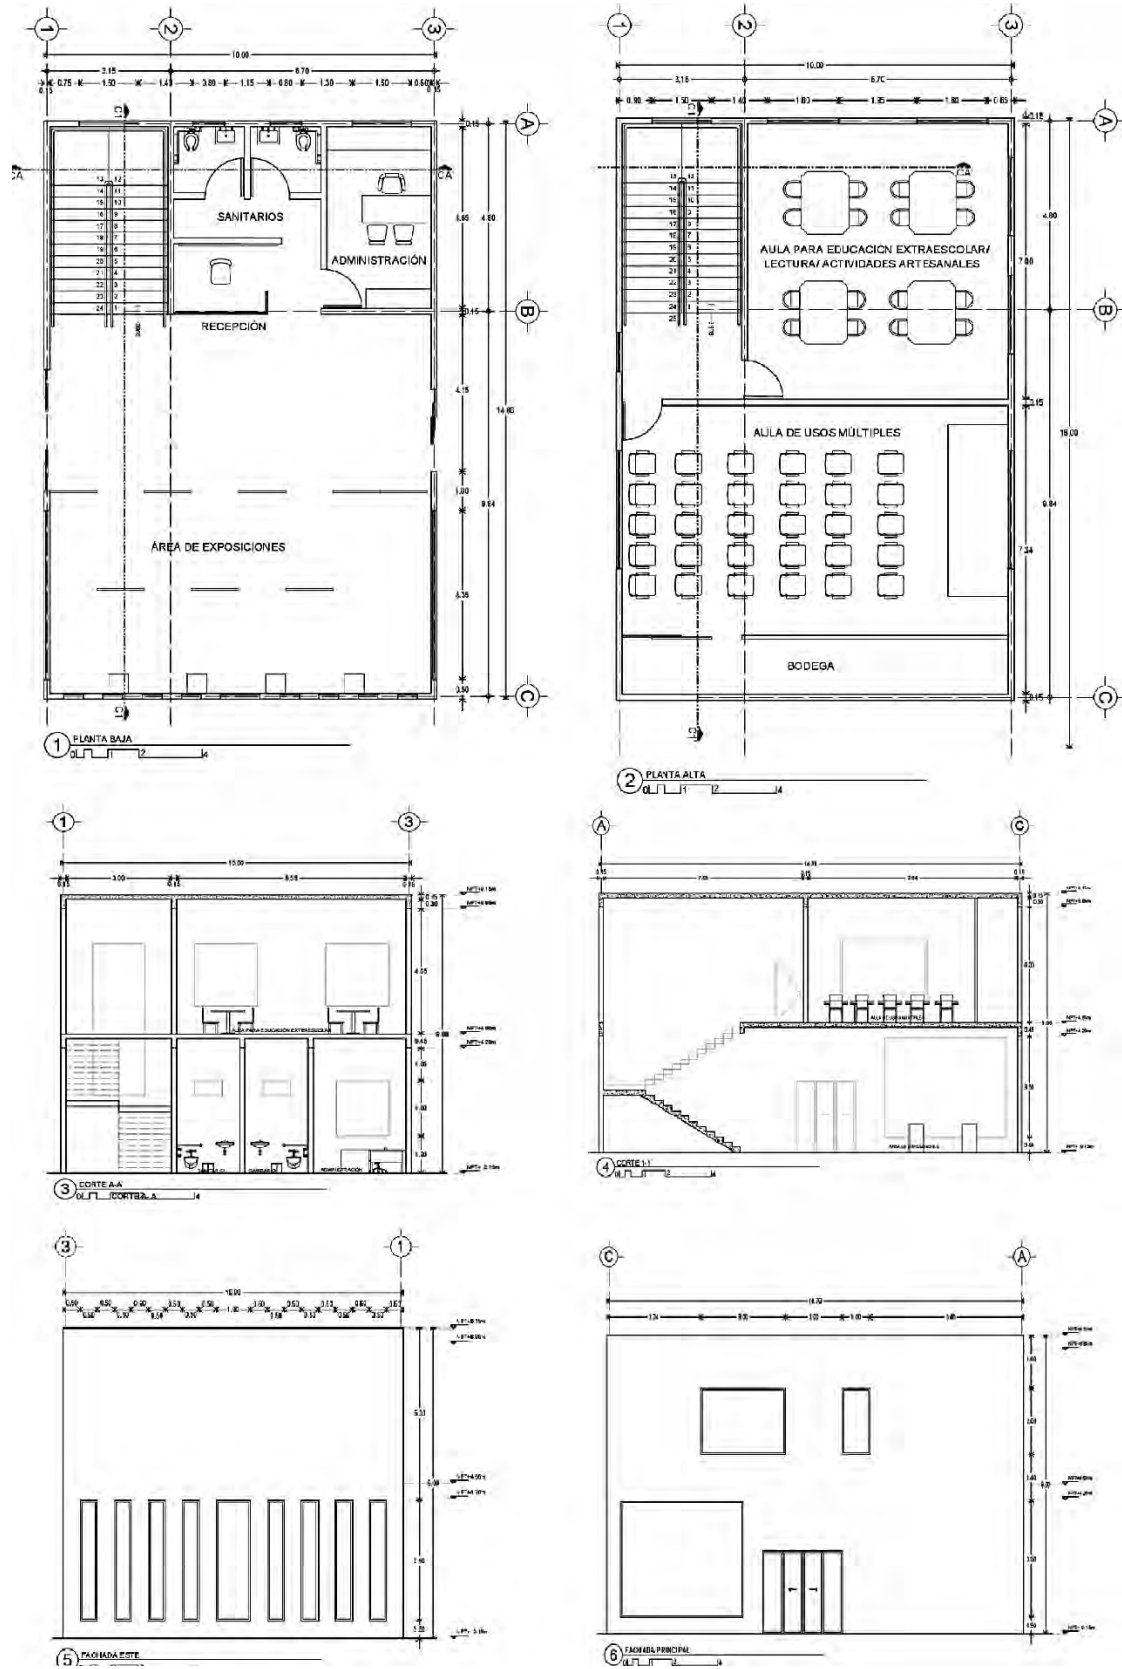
Plantas, cortes y fachadas del Centro Social.
